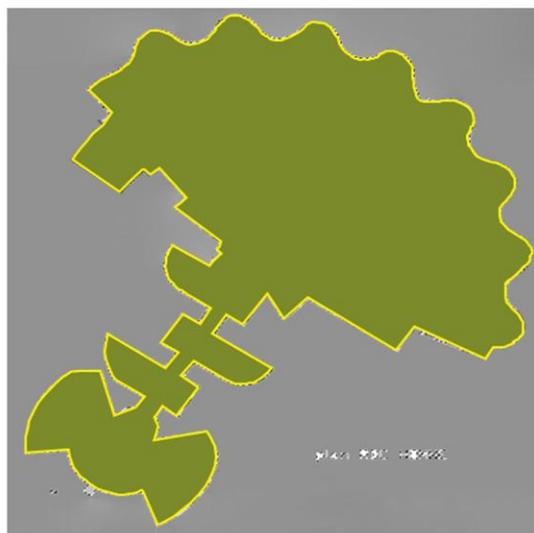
Plan d'aménagement du site Hammam Sahlane
